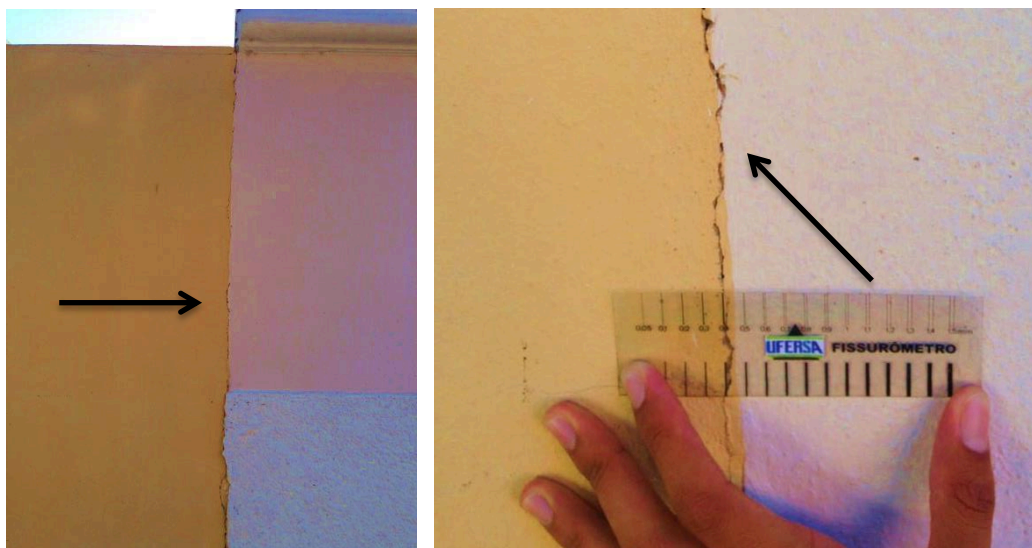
Fissura causada por Detalhes construtivos
